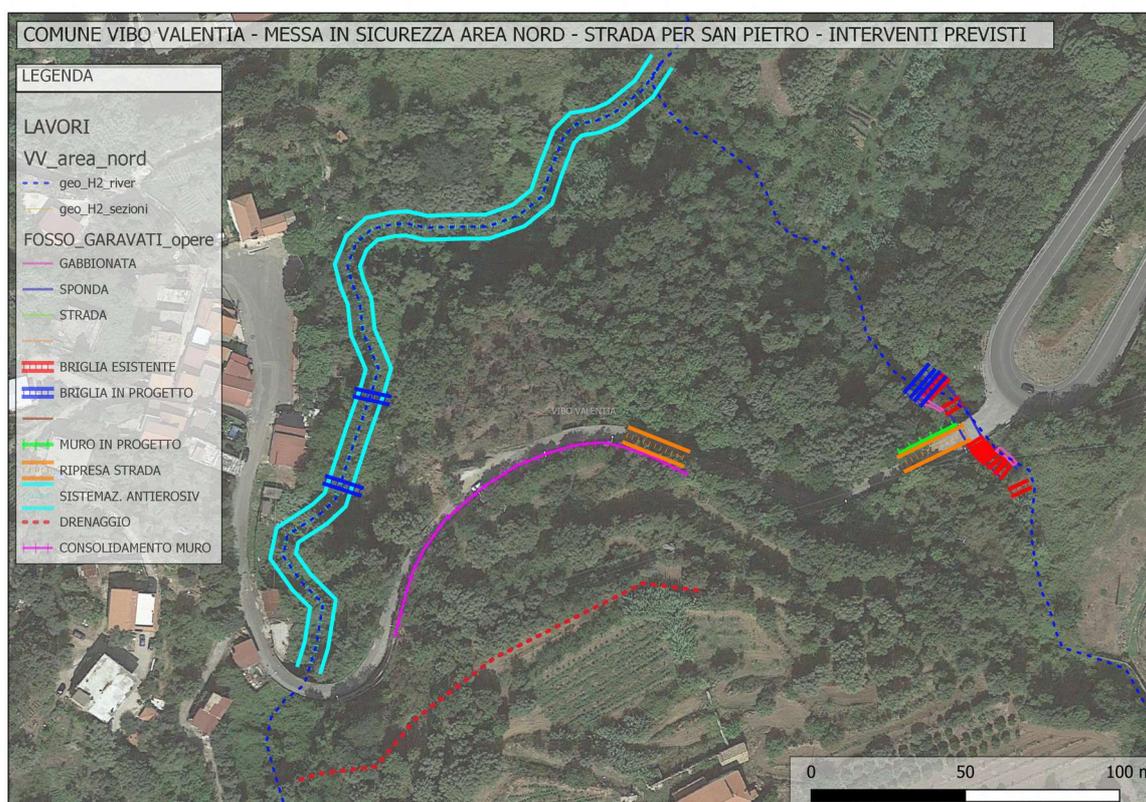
Planimetria generale interventi previsti – base ortofoto
